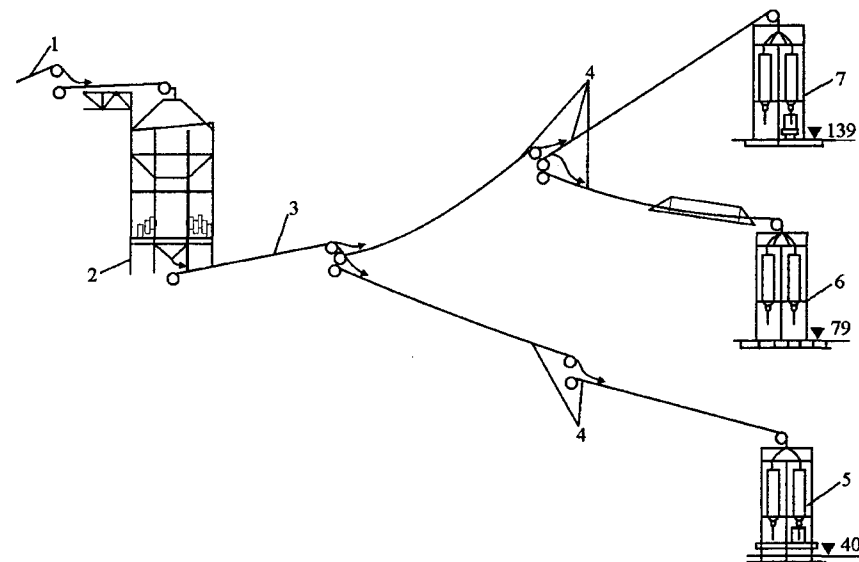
Схема конвейерных линий на строительстве плотины Фонтана в США: 1 – конвейер для заполнителей, 2 – бетонный завод, 3 – конвейер с лентой 1070 мм, 4 – конвейер с лентой 960 мм, 5 – бункера бетонной смеси здания ГЭС, 6 и 7 – бункеры бетонной смеси плотины на низкой и высокой эстакадах
